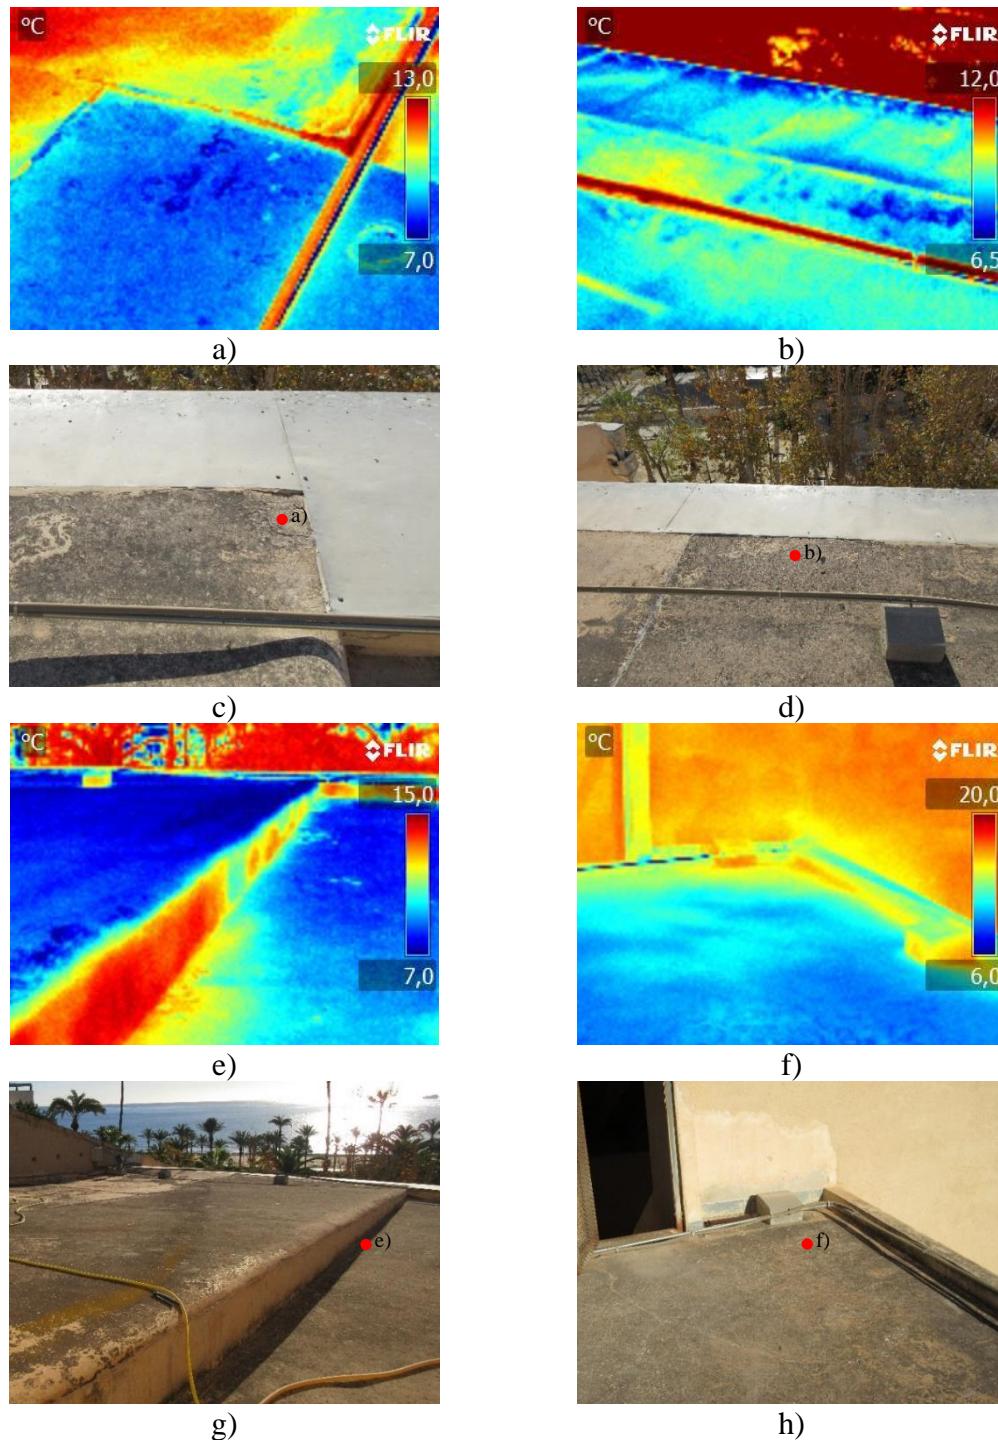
Termografía cubierta 2: a) Deterioro de junta perimetral, b) Detalle de fallo en junta perimetral en contacto del faldón con la fachada, c) y d) Imagen a) y b) con cámara digital, e) Detalle del extremo lateral del faldón y conexión con cubierta, f) Zona perimetral del faldón en zona de acceso a la cubierta; g) y h) Imagen e) y f) con cámara digital.
